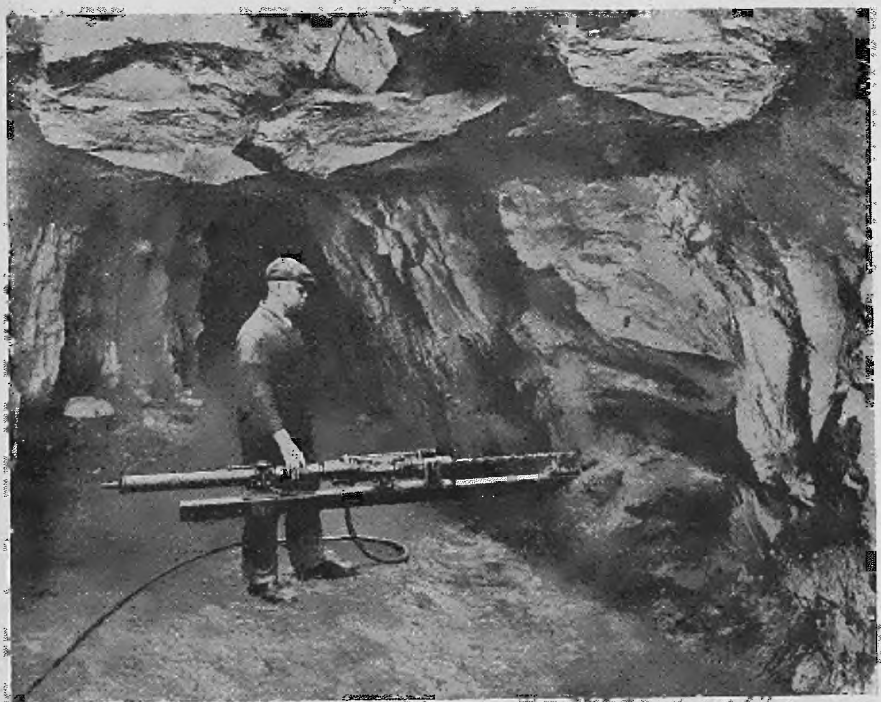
Haltevorrichtung für Bohrhammer mit Hammerschlitten
